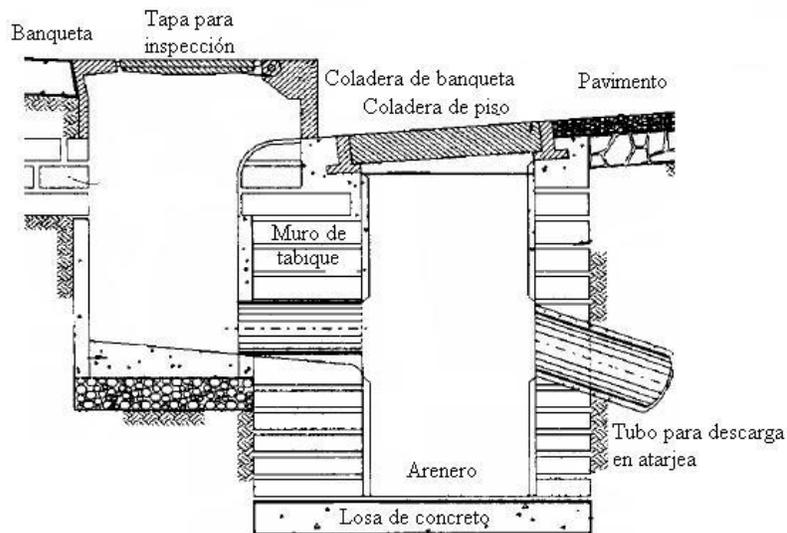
Estructura de coladera de piso y banquetta vista en corte transversal
